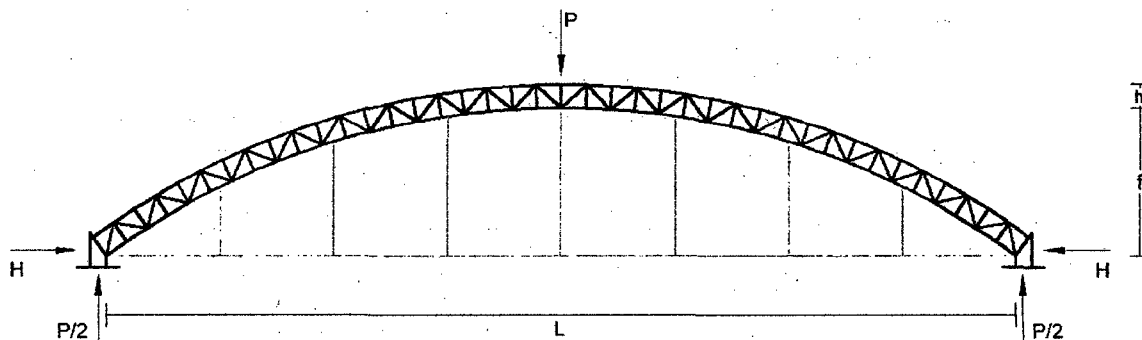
64: Celosía en arco tipo Warren con apoyos biarticulados
